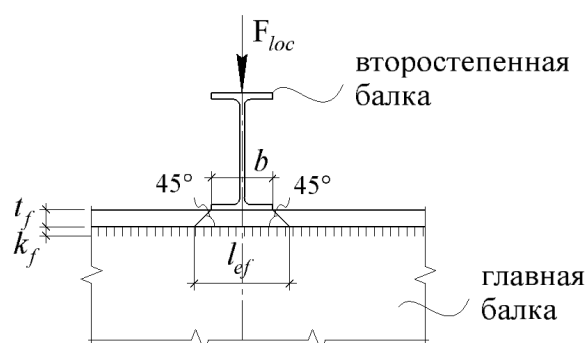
Схема передачи локальной нагрузки на стенку нижележащей балки при этажном опирании
